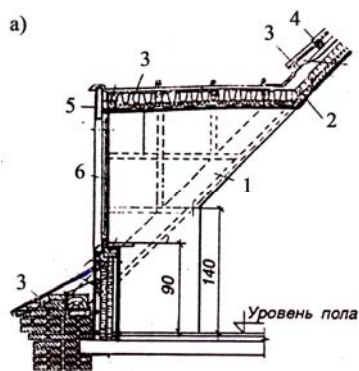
Схема вертикального участка стены высотой 0,9-1,4м в помещениях с наклонной наружной стеной(разрез по оконному проему):
